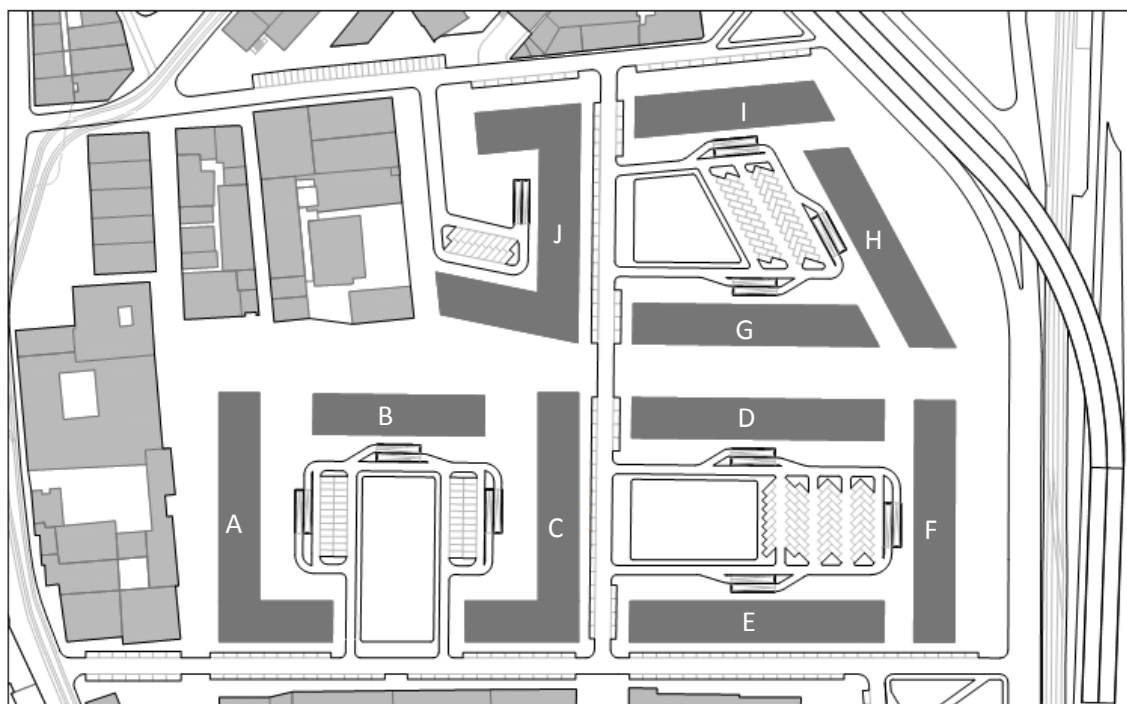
Planta de implantação dos novos edifícios propostos (fonte: autor).
